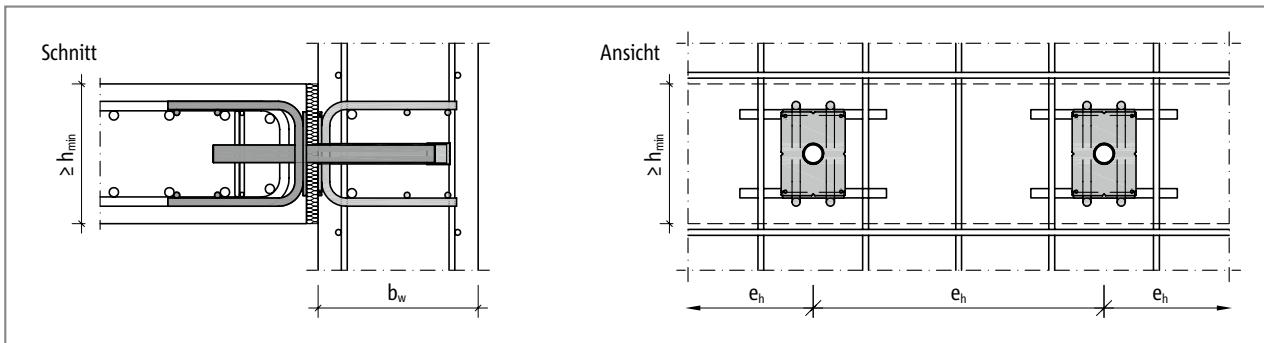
Schöck Dorn Typ SLD: Bauseitigen Bewehrung bei Decke-Wand Anschluss
